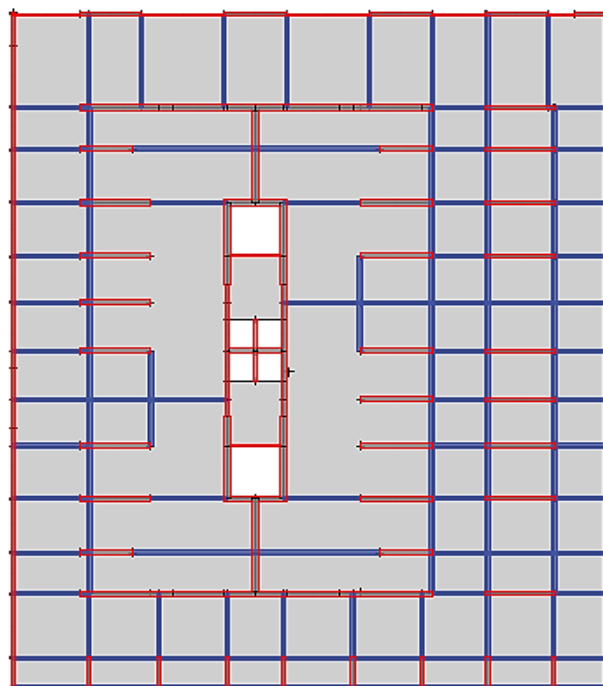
Vue en plan de rez de chaussée (RDC)
